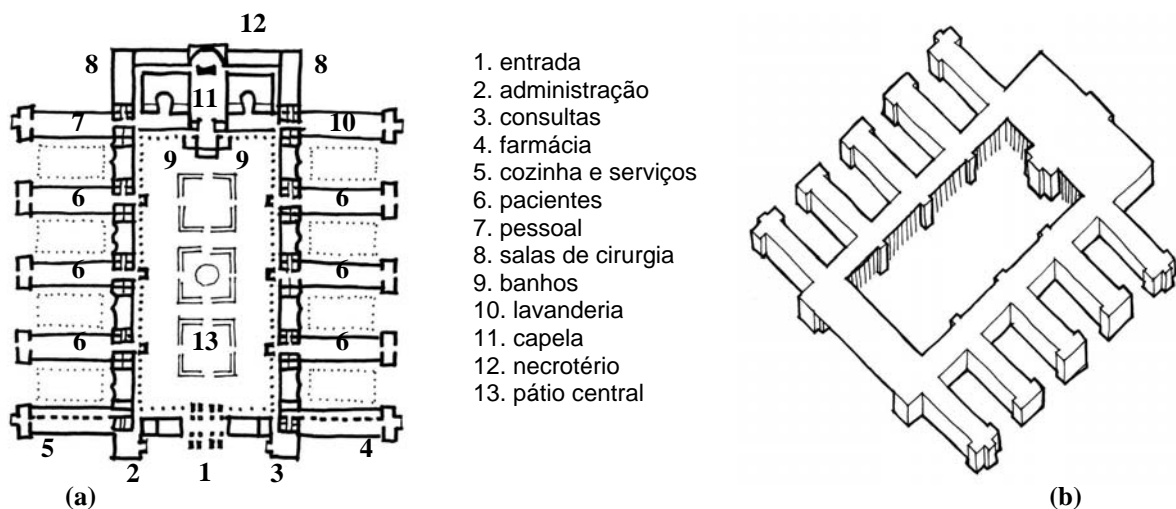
Royal Naval Hospital, Inglaterra, 1756-1764. (a) planta; (b) croqui.
